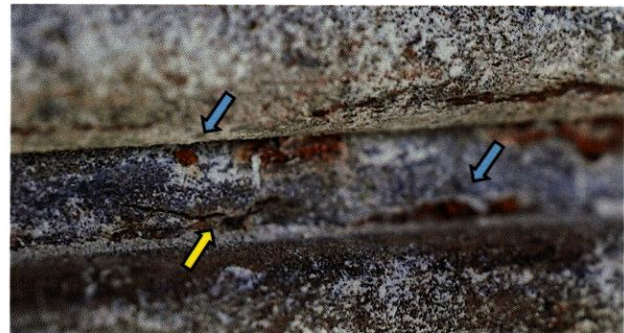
Imagen en primer plano de un cable de postensado de la Viga Norte en el Sitio B, que muestra corrosión por picaduras (flechas azules) y señales de agrietamiento (flecha amarilla).
